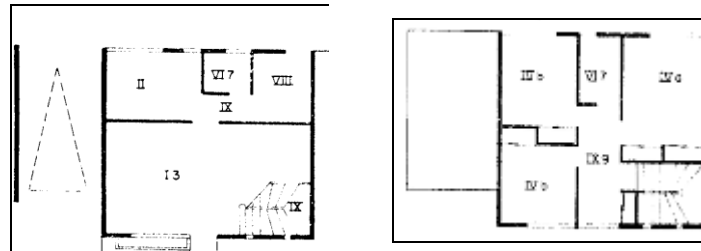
f. Vivienda LV-2. Plantas Baja y Alta
